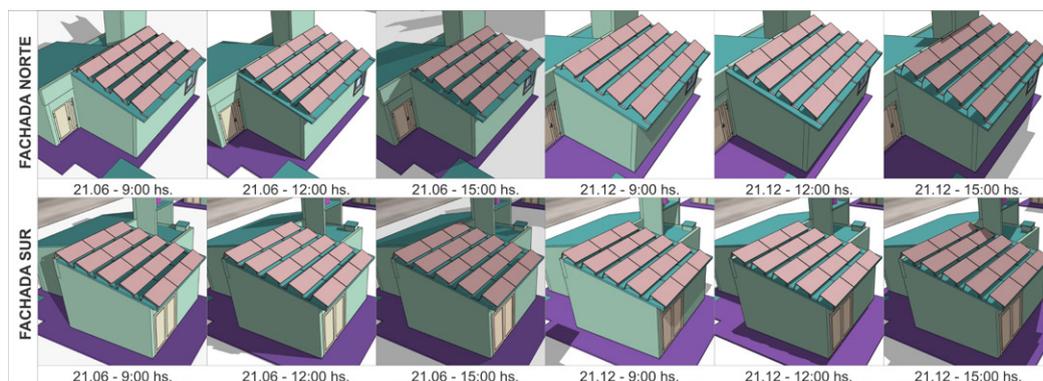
| Sombra sobre paneles en fachada norte y sur en el solsticio de verano e invierno Fuente: elaboración propia.
